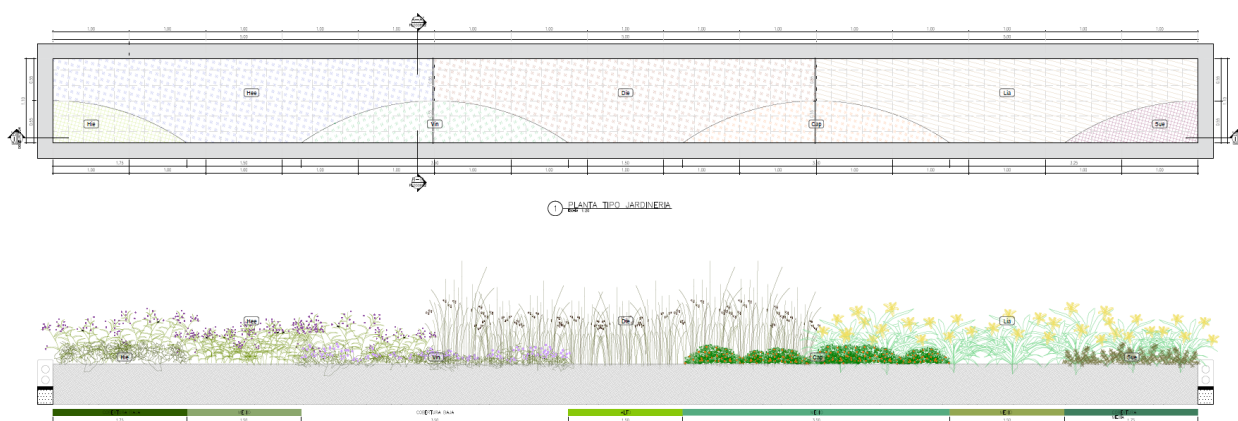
Planta y alzado detalle diseño de jardinería en franja
